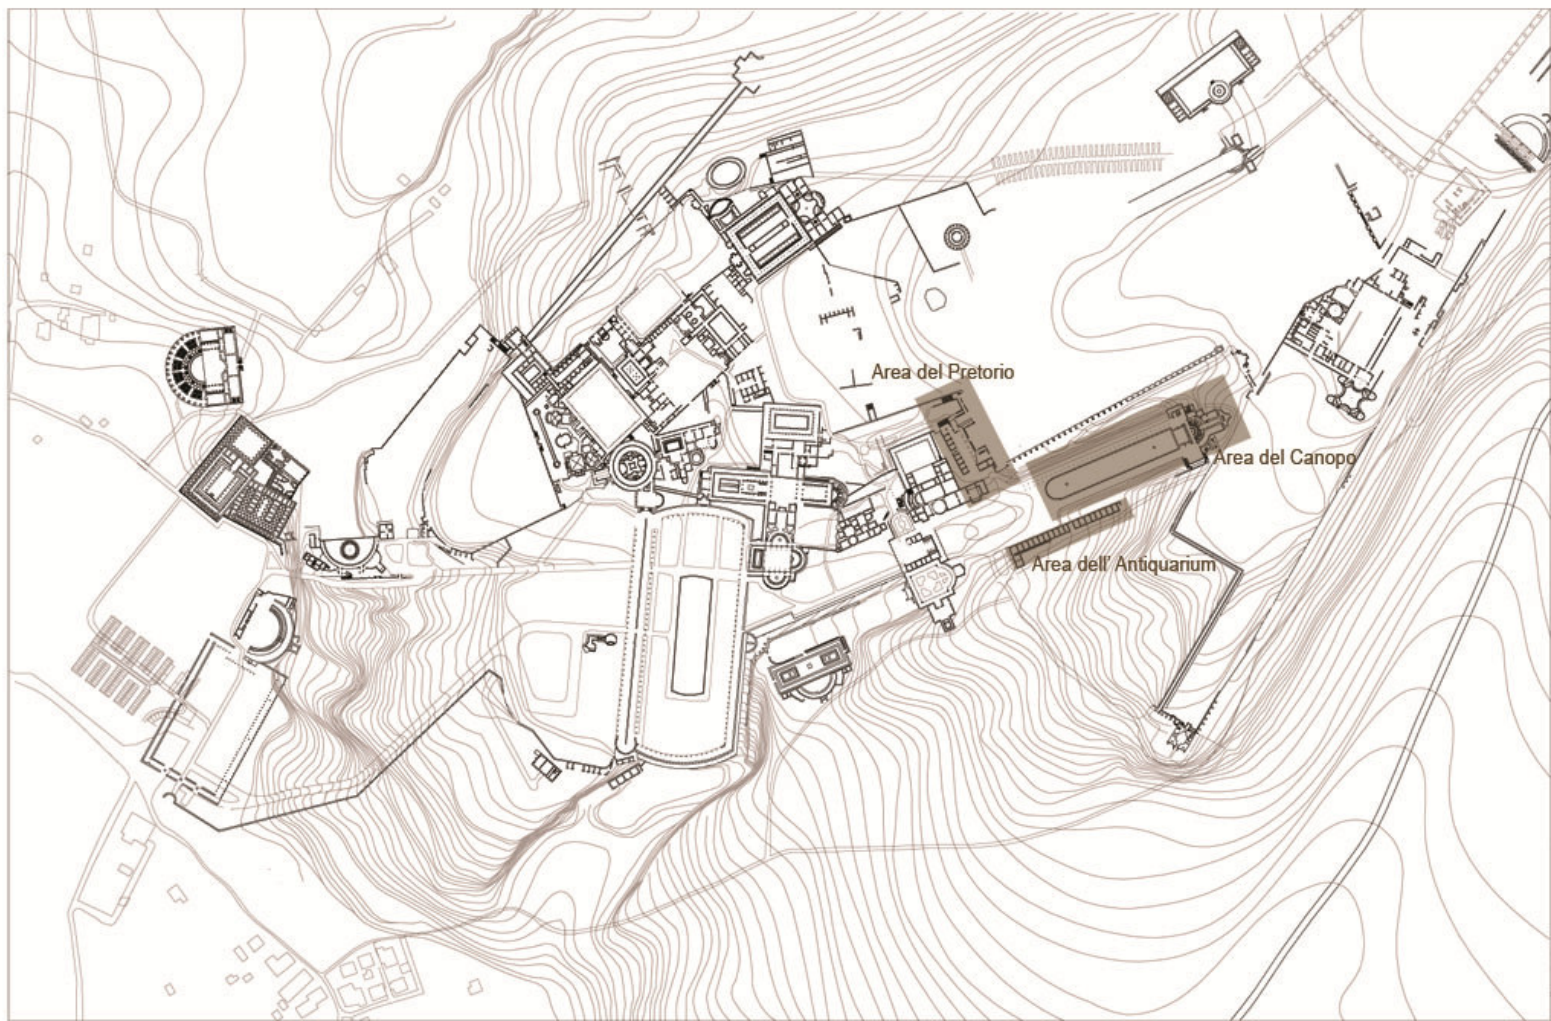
Planimetria di Villa Adriana con indicazione delle zone considerate, Pretorio, Canopo ed Antiquarium
